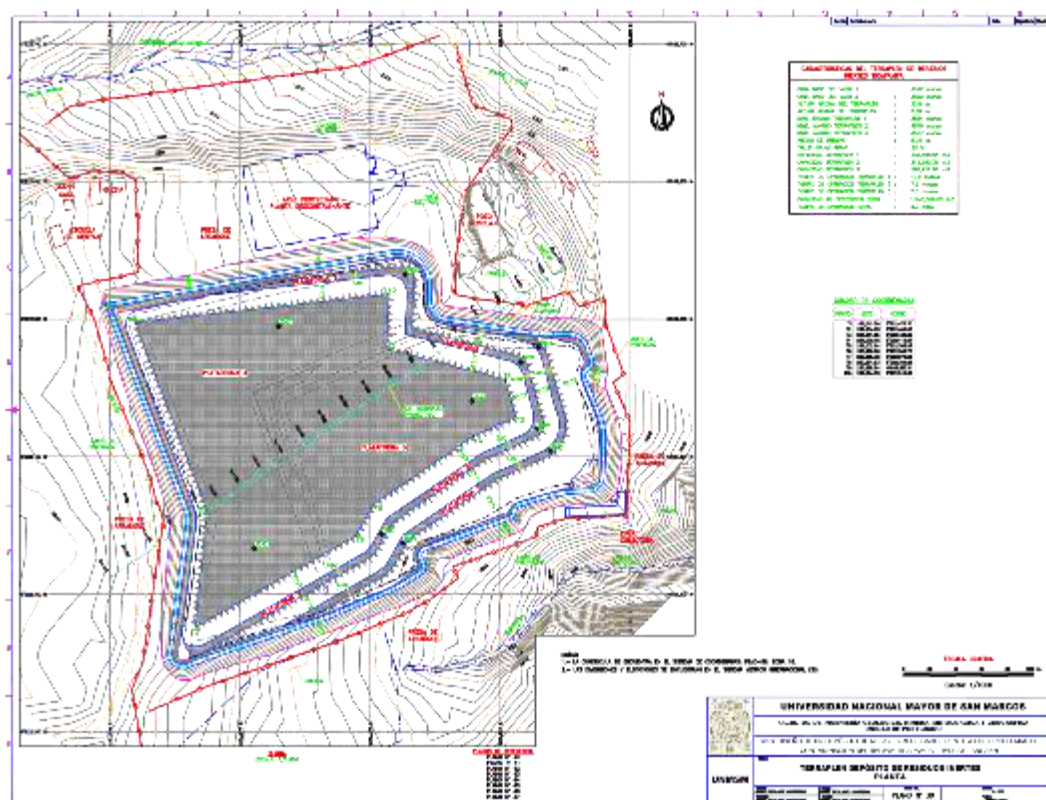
Plano en planta terraplén depósitos de residuos inertes.
